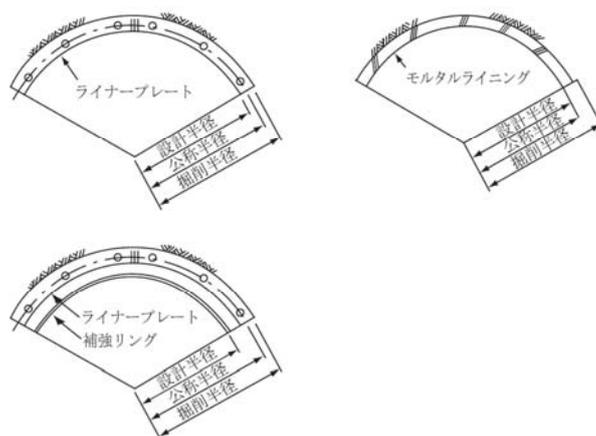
深礎基礎の設計径（道示IV編, 図-解 14.4.1）
